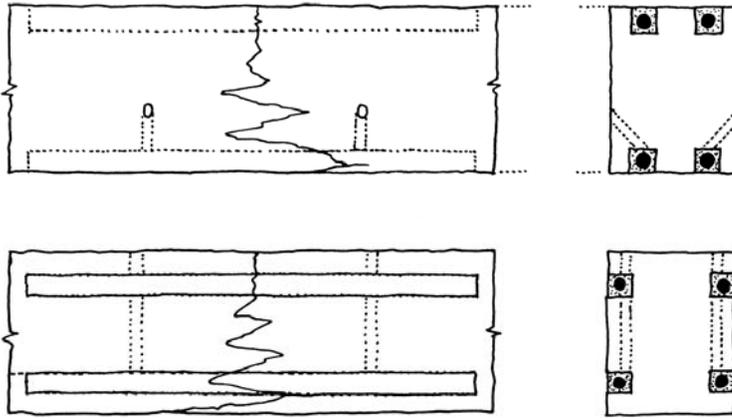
Consolidación de una viga mediante barras de refuerzo.
